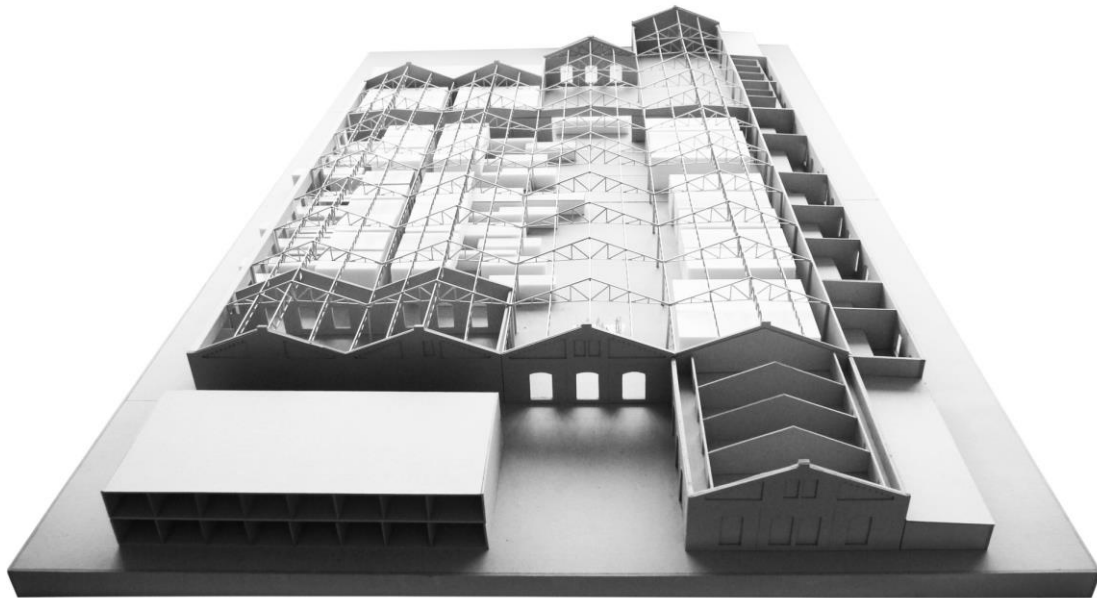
Maquette du centre culturel Wagenhallen Stuttgart.
